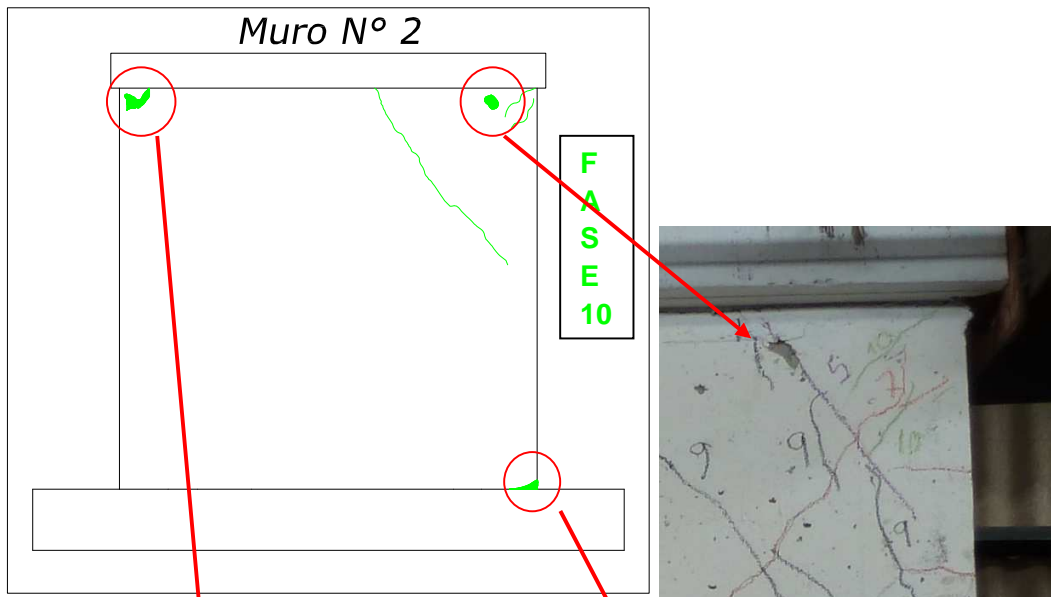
Fisuras en la Fase 10 Muro M-2
